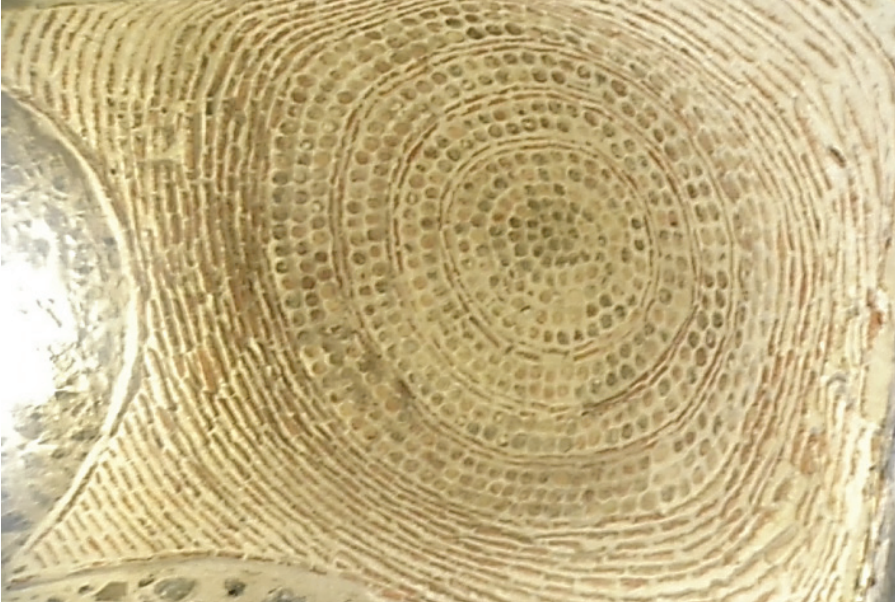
Hasan Paşa Hamı Üst Kat Odalarını Örtten Kubbe Detayı.
